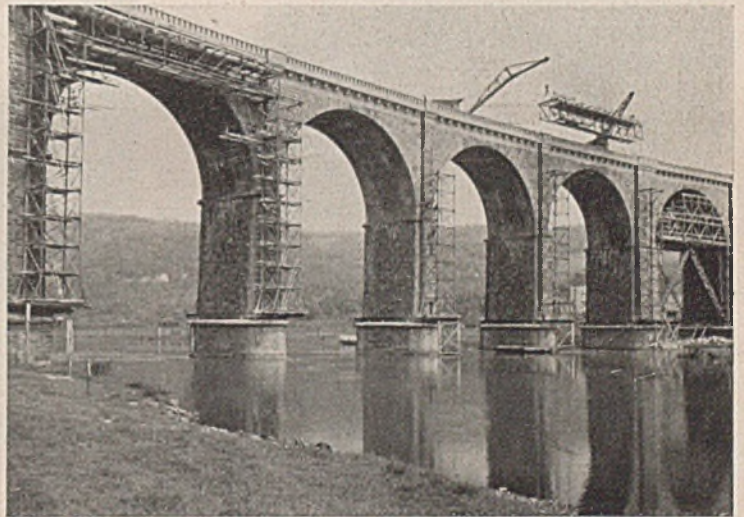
Bekrönung des Bauwerks teilweise fertig, Abbau der Rüstungen.
